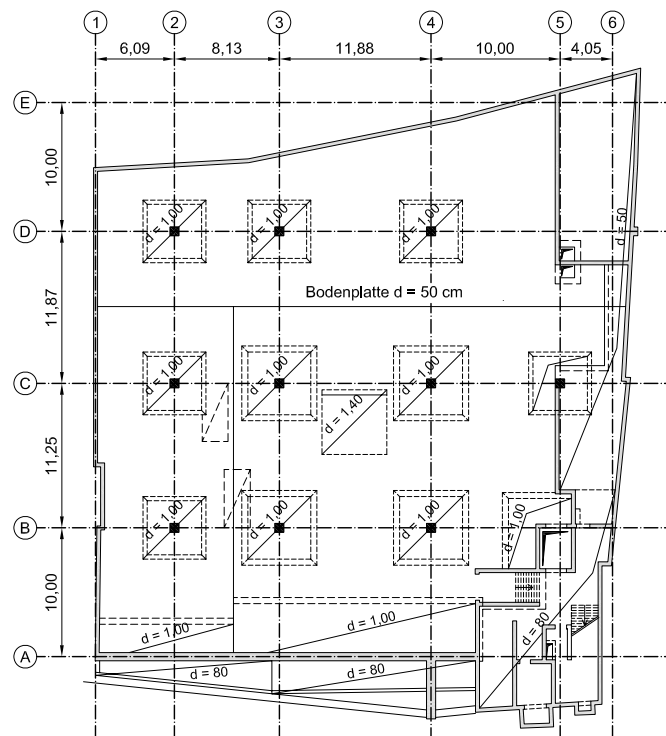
Grundriss der Bodenplatte mit Plattenstärken [11]
